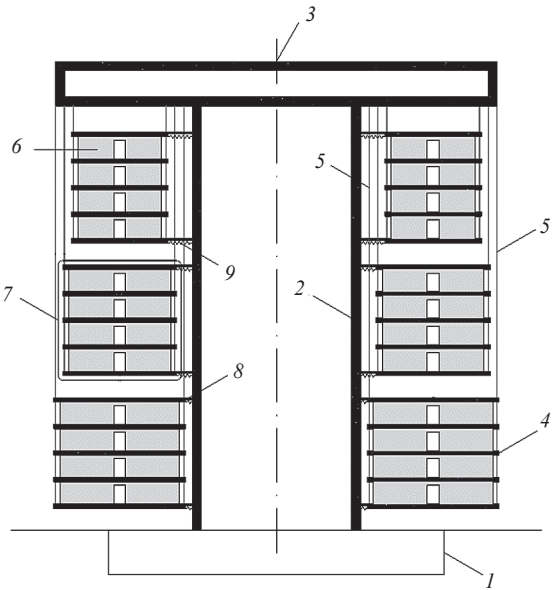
Здание с подвешенными блоками этажей: 1 — фундамент; 2 — несущий ствол; 3 — консольный ростверк; 4 — плиты перекрытий; 5 — подвески; 6 — диафрагмы жесткости; 7 — геометрически неизменяемые блоки этажей; 8 — выключающиеся связи; 9 — упругие связи
